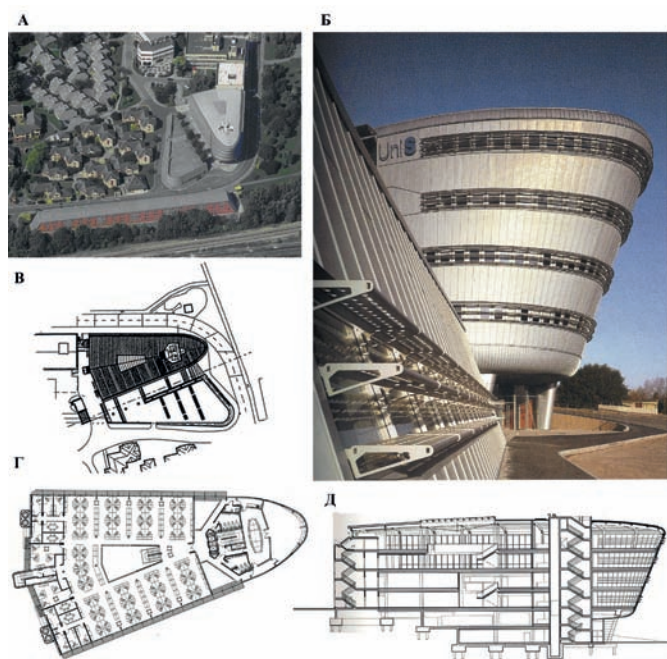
Комплекс медицинского факультета Европейского института здоровья «Duke of Kent»: А – вид сверху; Б – общий вид; В – схема генплана; Г – план рабочего этажа; Д – продольный разрез
